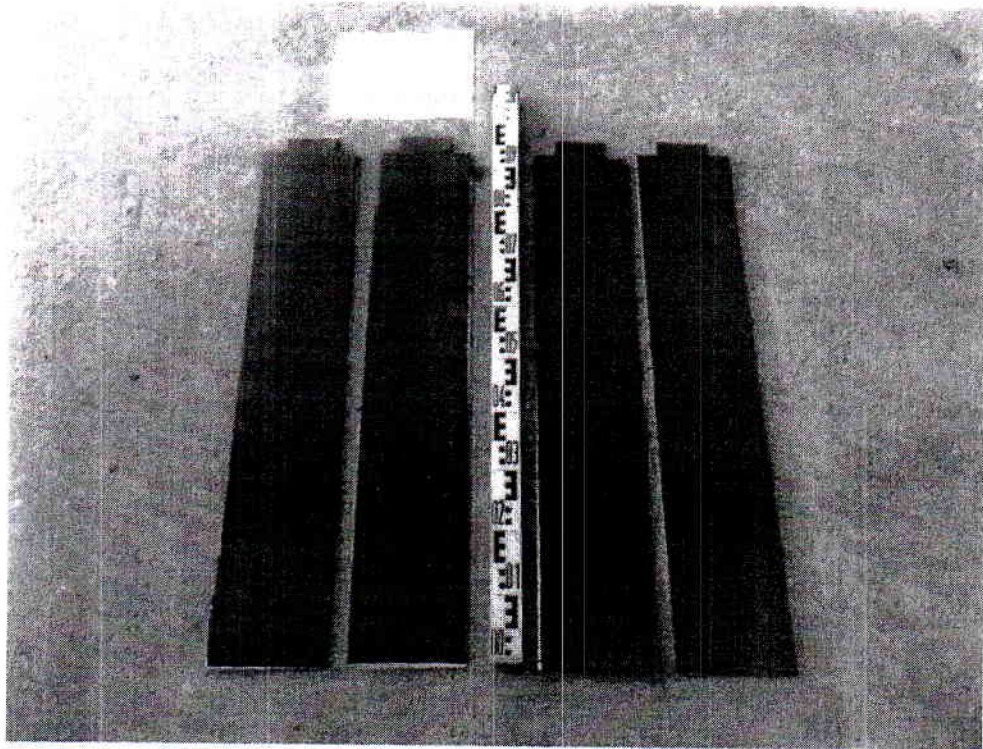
Izlaganje bridova plamenu (d=19,0 mm)
